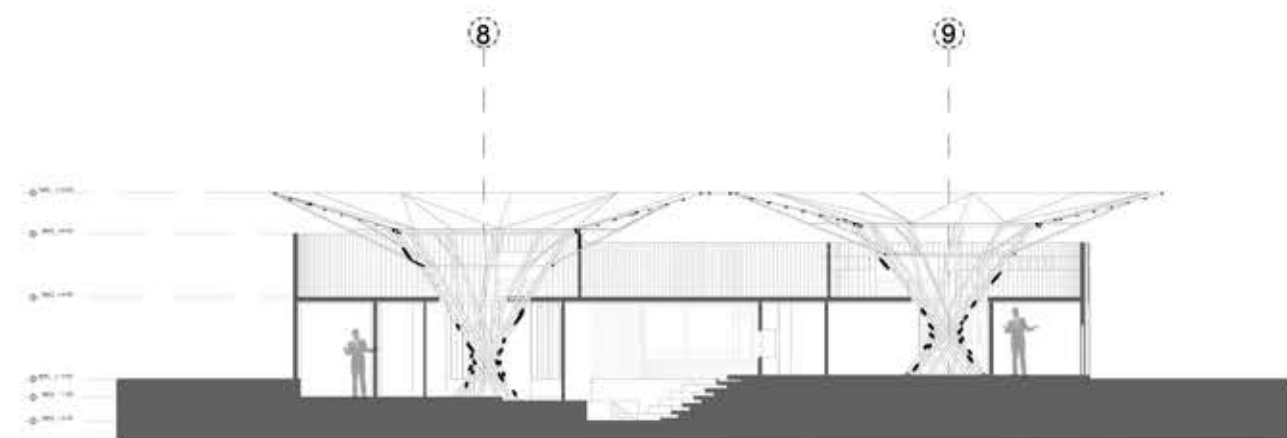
Bedoya David (2021) Sección Arquitectonica (imagen41.png)
